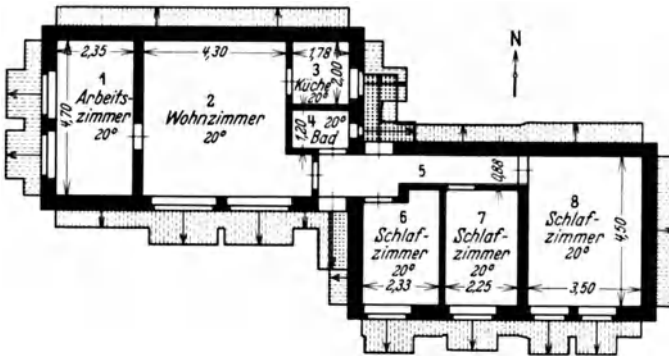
Erhöhter Wärmebedarf durch langgestreckten Grundriß. (Nach G. Reichow.)
